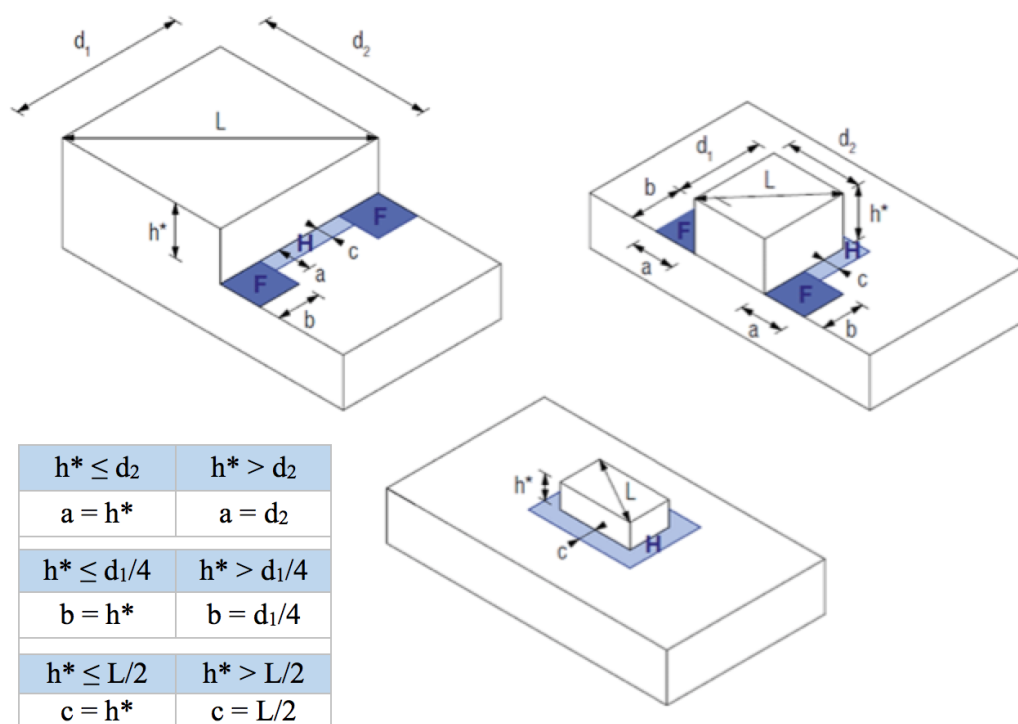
Zones complémentaires sur des toitures à plusieurs niveaux
